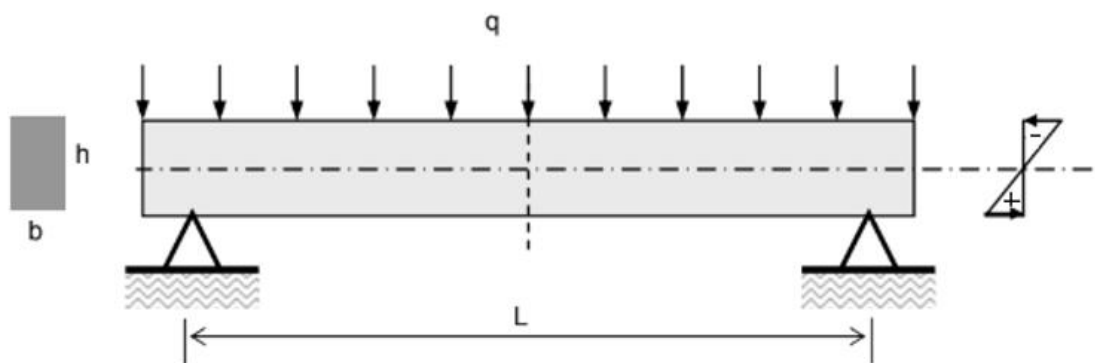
Viga de hormigón sometida a una carga distribuida q (4).
